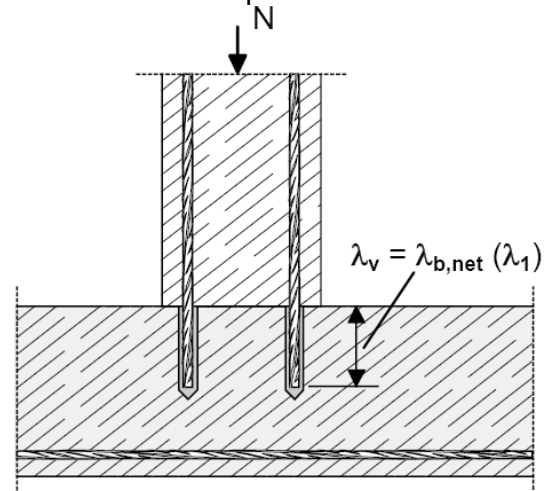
Jonction à recouvrement au droit de la fondation d'un pilier ou d'un mur avec armatures sollicitées en traction
